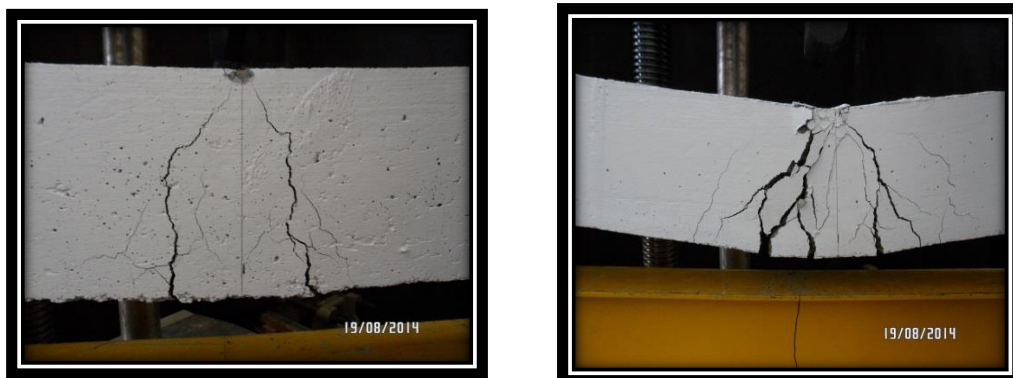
Fisuras en vigas sub-reforzadas.
